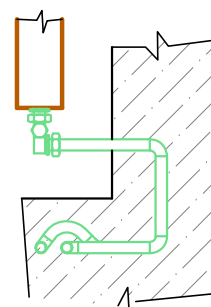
#### DETAIL NAPOJENÍ TĚLES VK POTRUBÍM VEDENÝM PO STĚNĚ M 1:10
